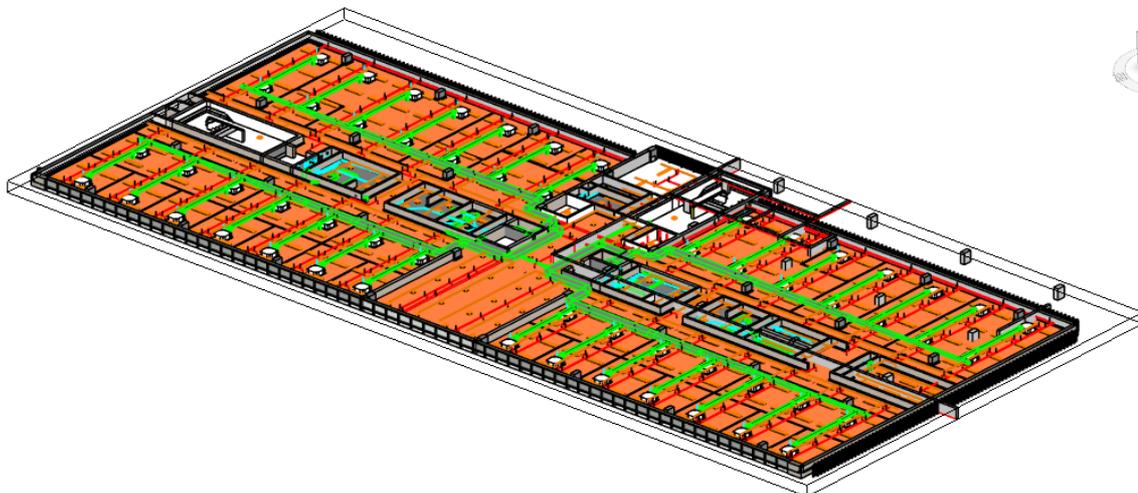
Pavimento Tipo (compatibilização) - Modelo Federado - PJSO - Sobradinho
